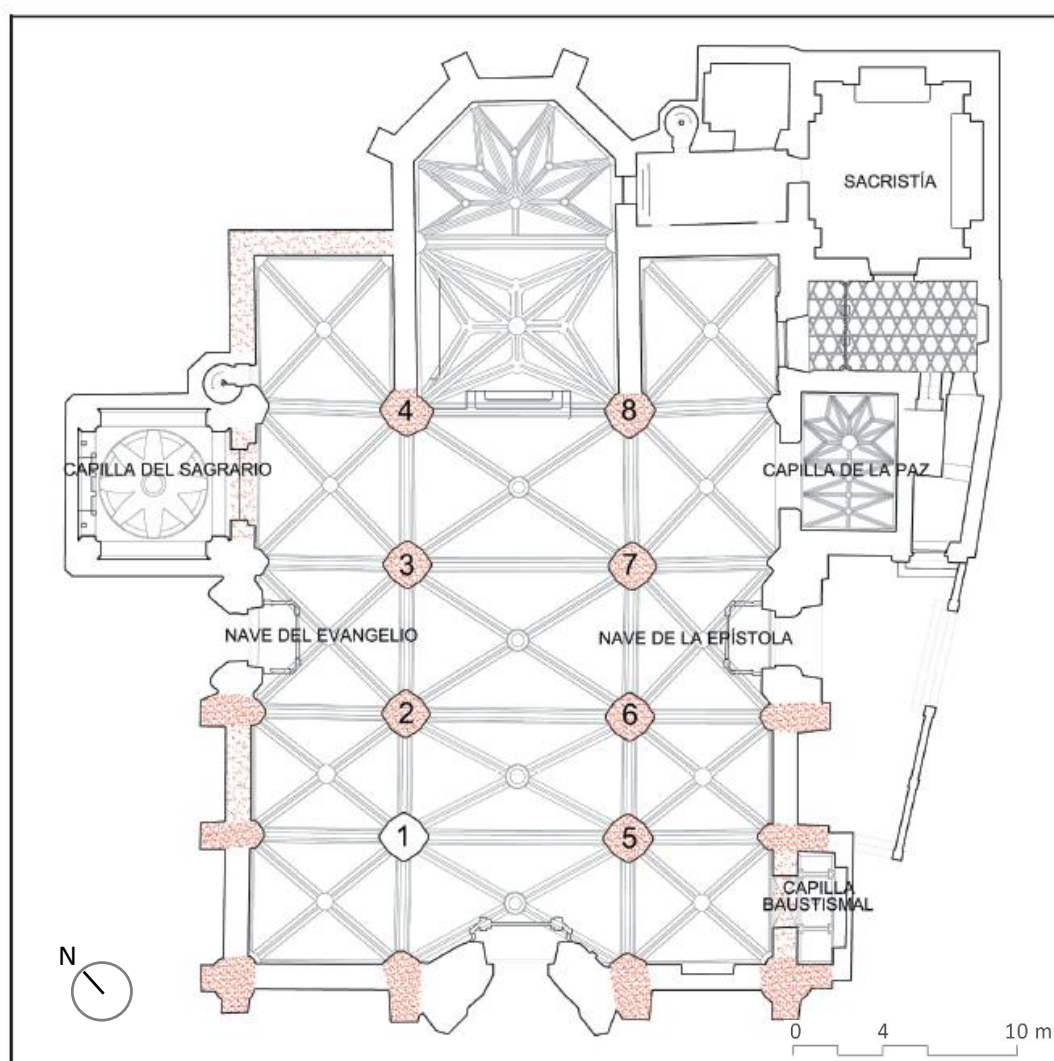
Planta de los elementos a consolidar mediante inyección (en rojo).
